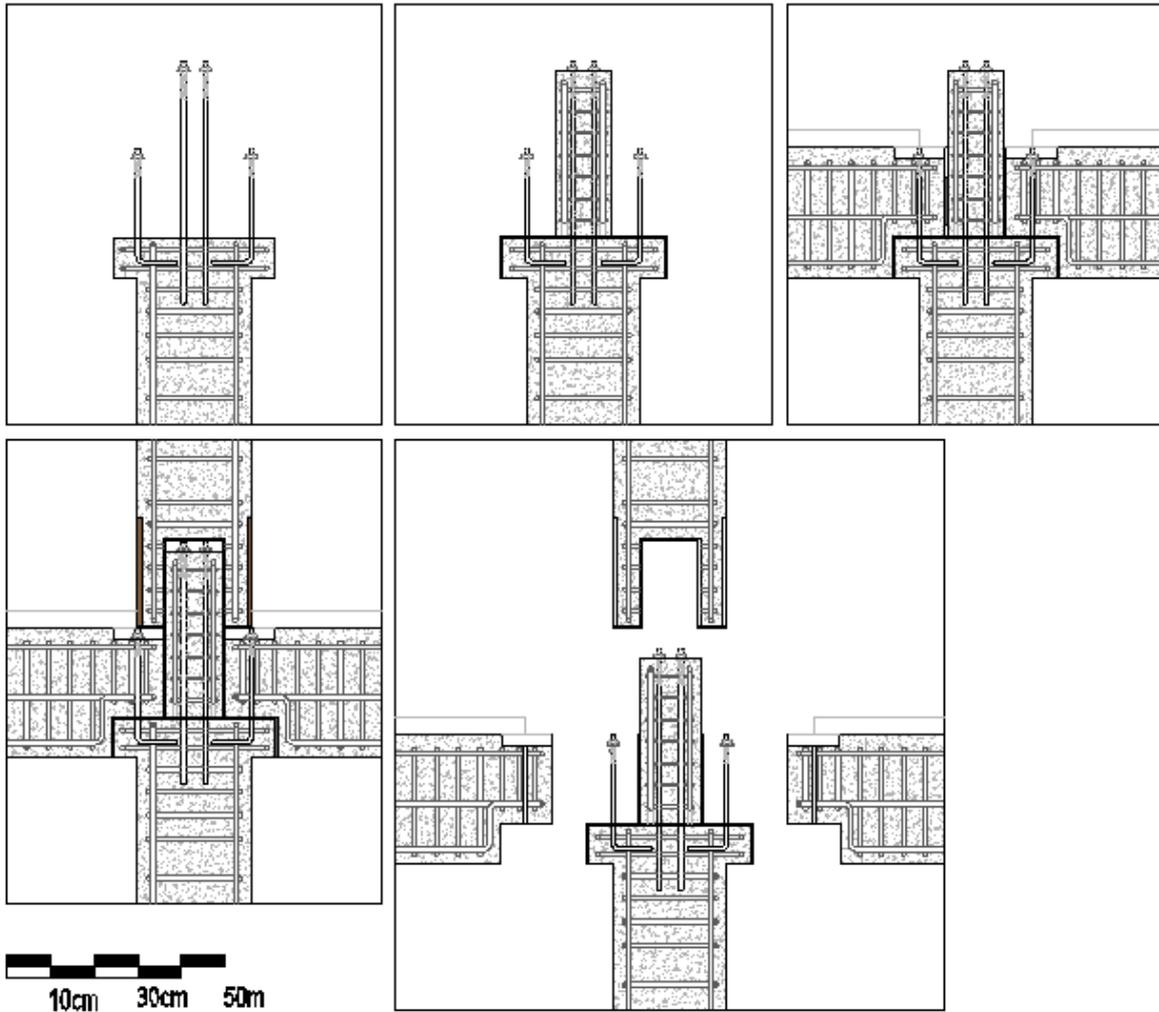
Proceso de unión estructural en pilar tipo 4 y 5.
